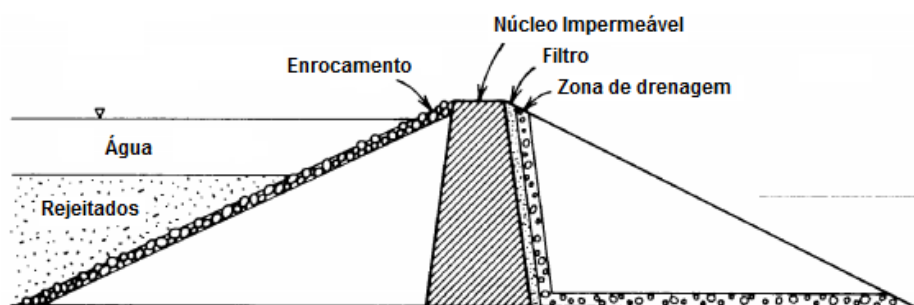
Secção transversal de uma barragem de retenção de rejeitados (adaptado de VICK, 1990).
